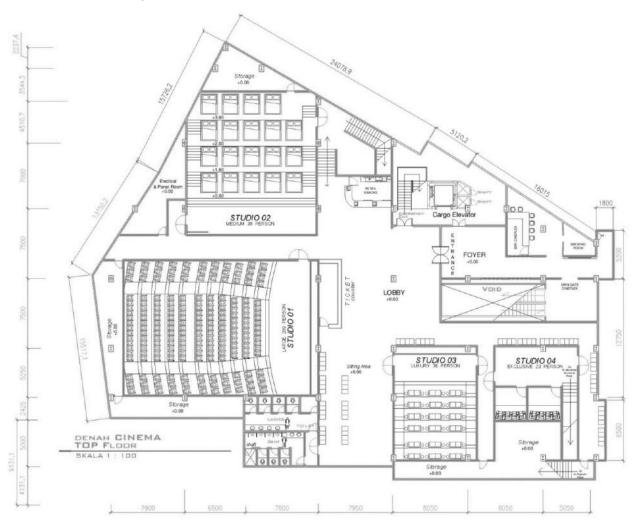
Alternatif 2 Layout Denah – Sinepleks Brylian Plaza Kendari (Mezanine Floor)
